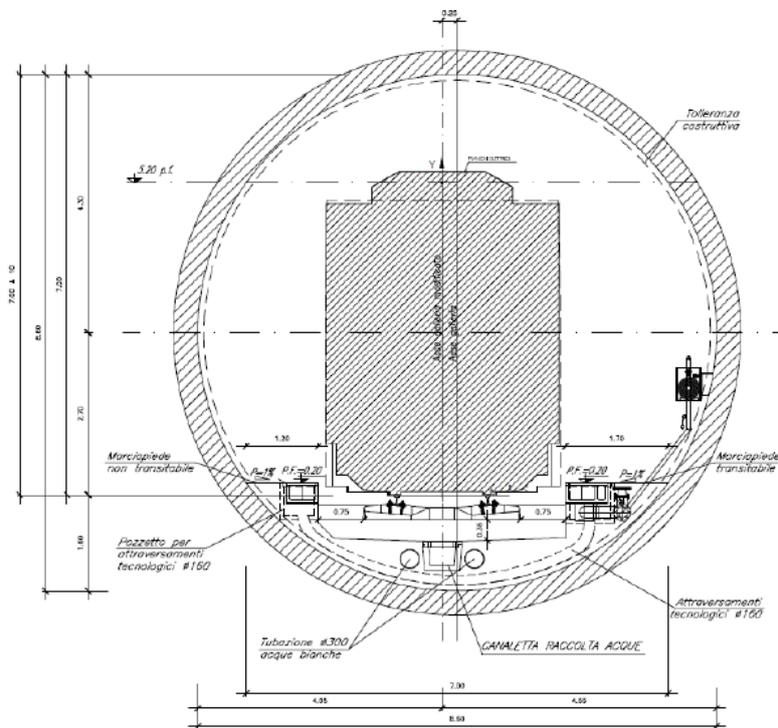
Sezione di scavo in meccanizzato – Soluzione della presente revisione progettuale
